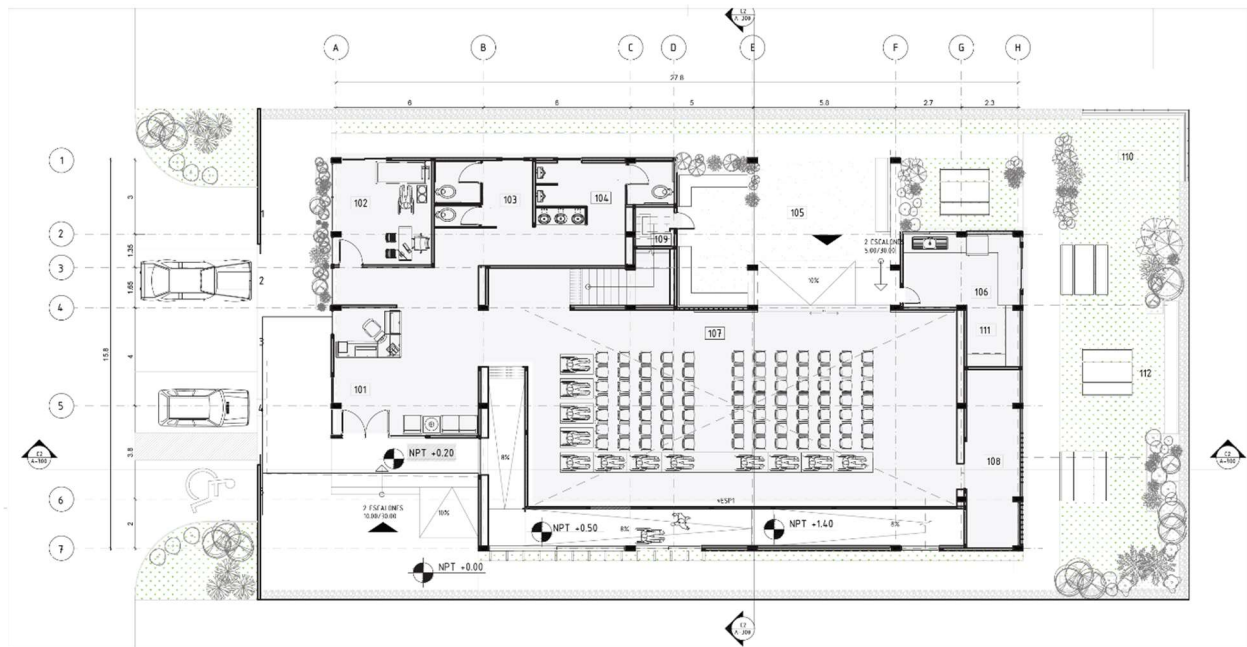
Planta arquitectónica primera propuesta para Casa del Adulto Mayor
